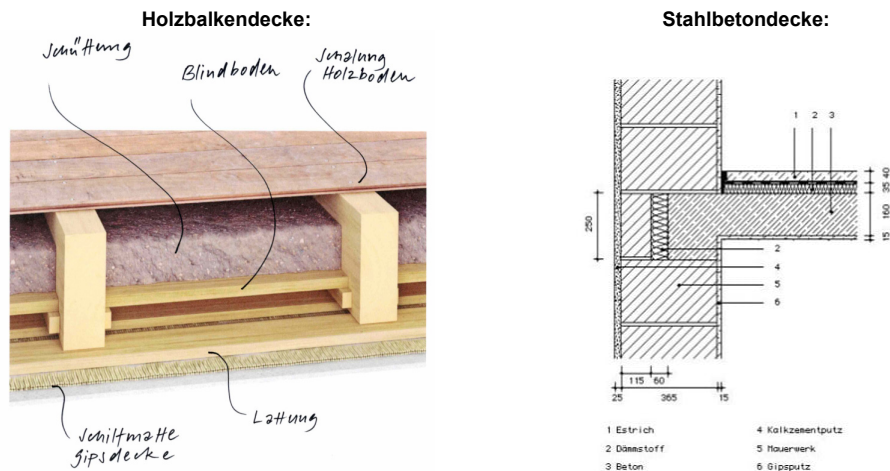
Holzbalken- und Stahlbetondecke als typische Geschossdecken in älteren Bestandsbauten, für die geeignete Massnahmen zur Erhöhung von Schallschutz und thermischer Behaglichkeit vorgeschlagen werden (Quellen: Architektur H. Baumann, www.baunetzwissen.de).
